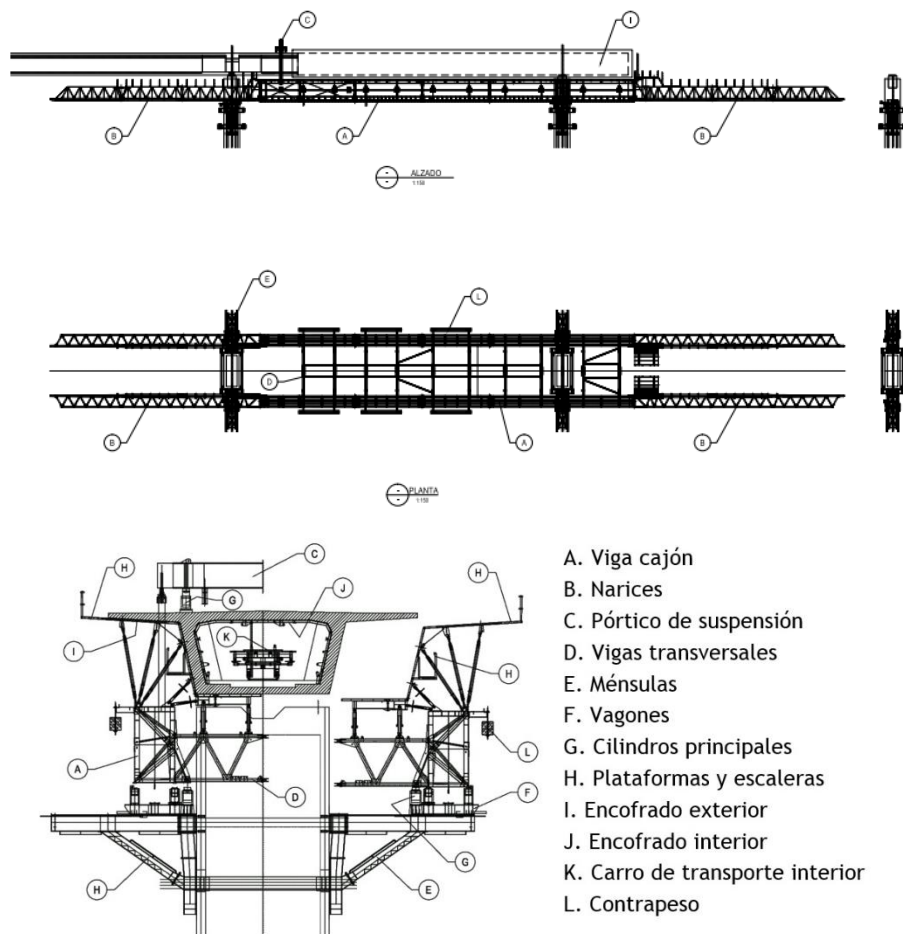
Planos cimbra autoportante bajo tablero. Fuente [19]
